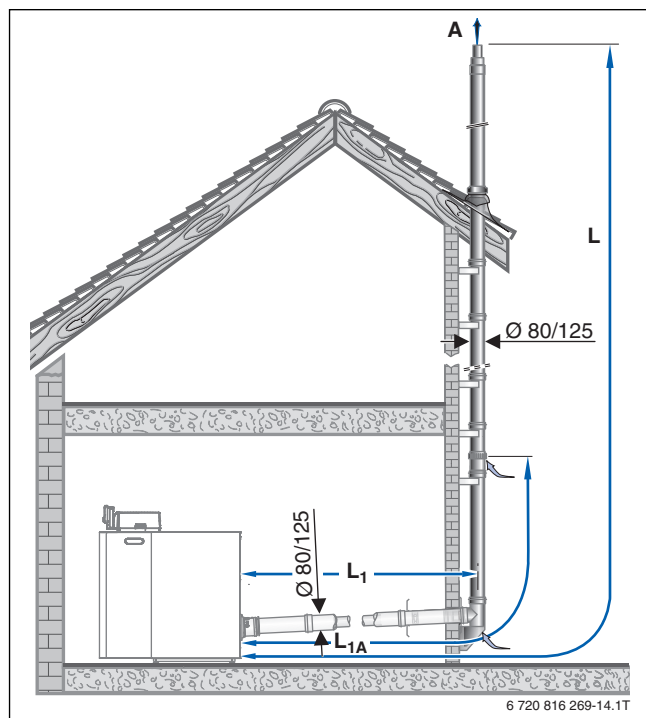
Guía de tubo concéntrico en la fachada (C_{53(x)})
